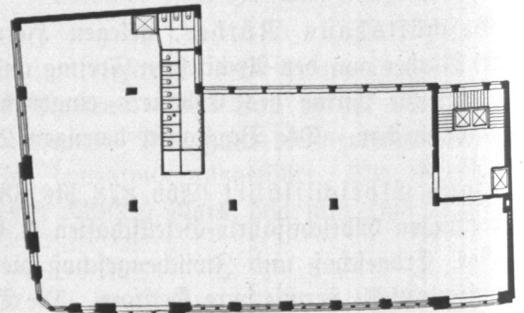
Haus Elbeschiffahrt, Obergeschoss.
